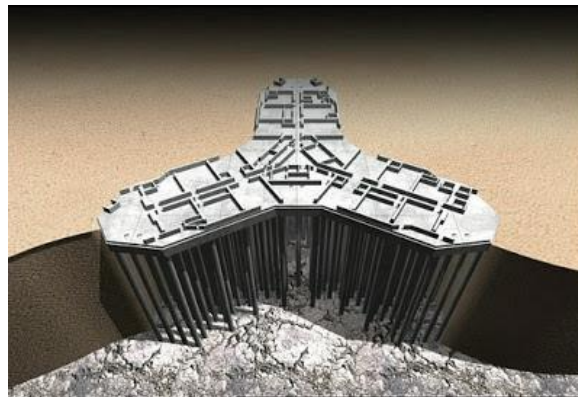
Esquema de cimentación edificio Burj Khalifa, extraída de internet
